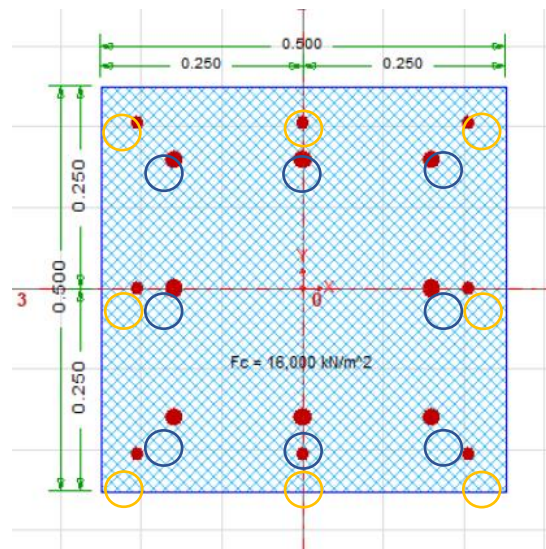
Reforzamiento en columnas de concreto, Fuente: propia
